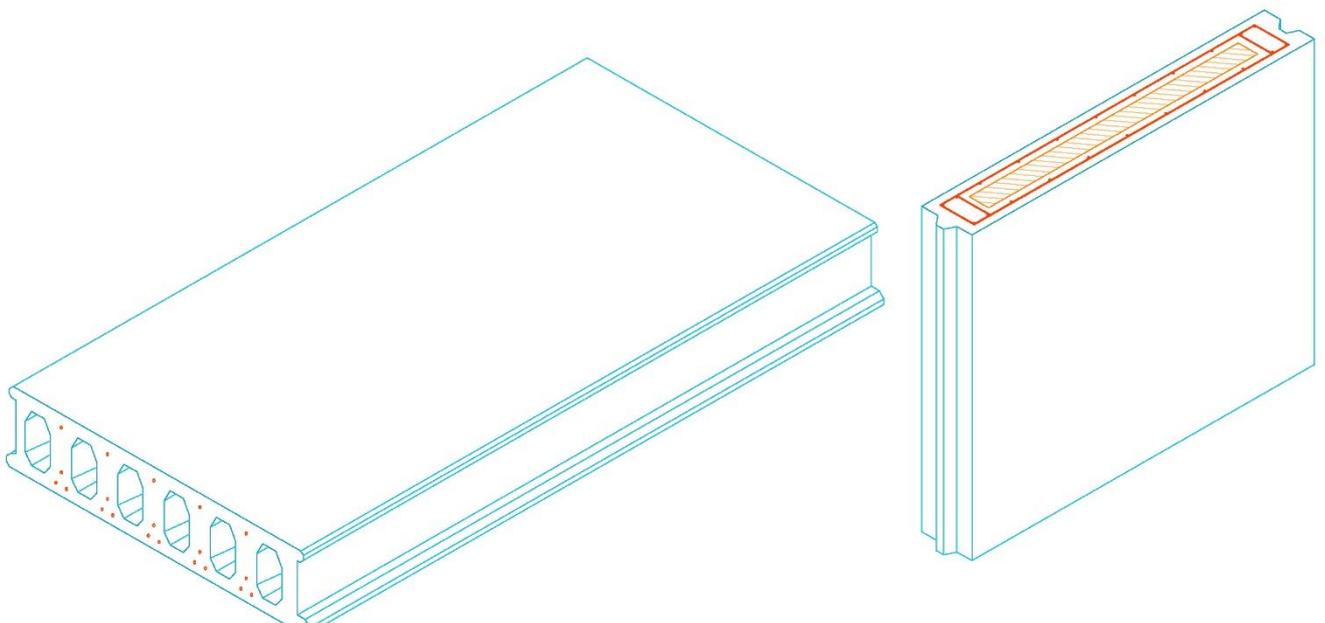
Elementos del sistema. Placa alveolar de hormigón prefabricado en la izquierda y placa de hormigón prefabricado armado y con aislante térmico a la derecha. (Dibujo original)
